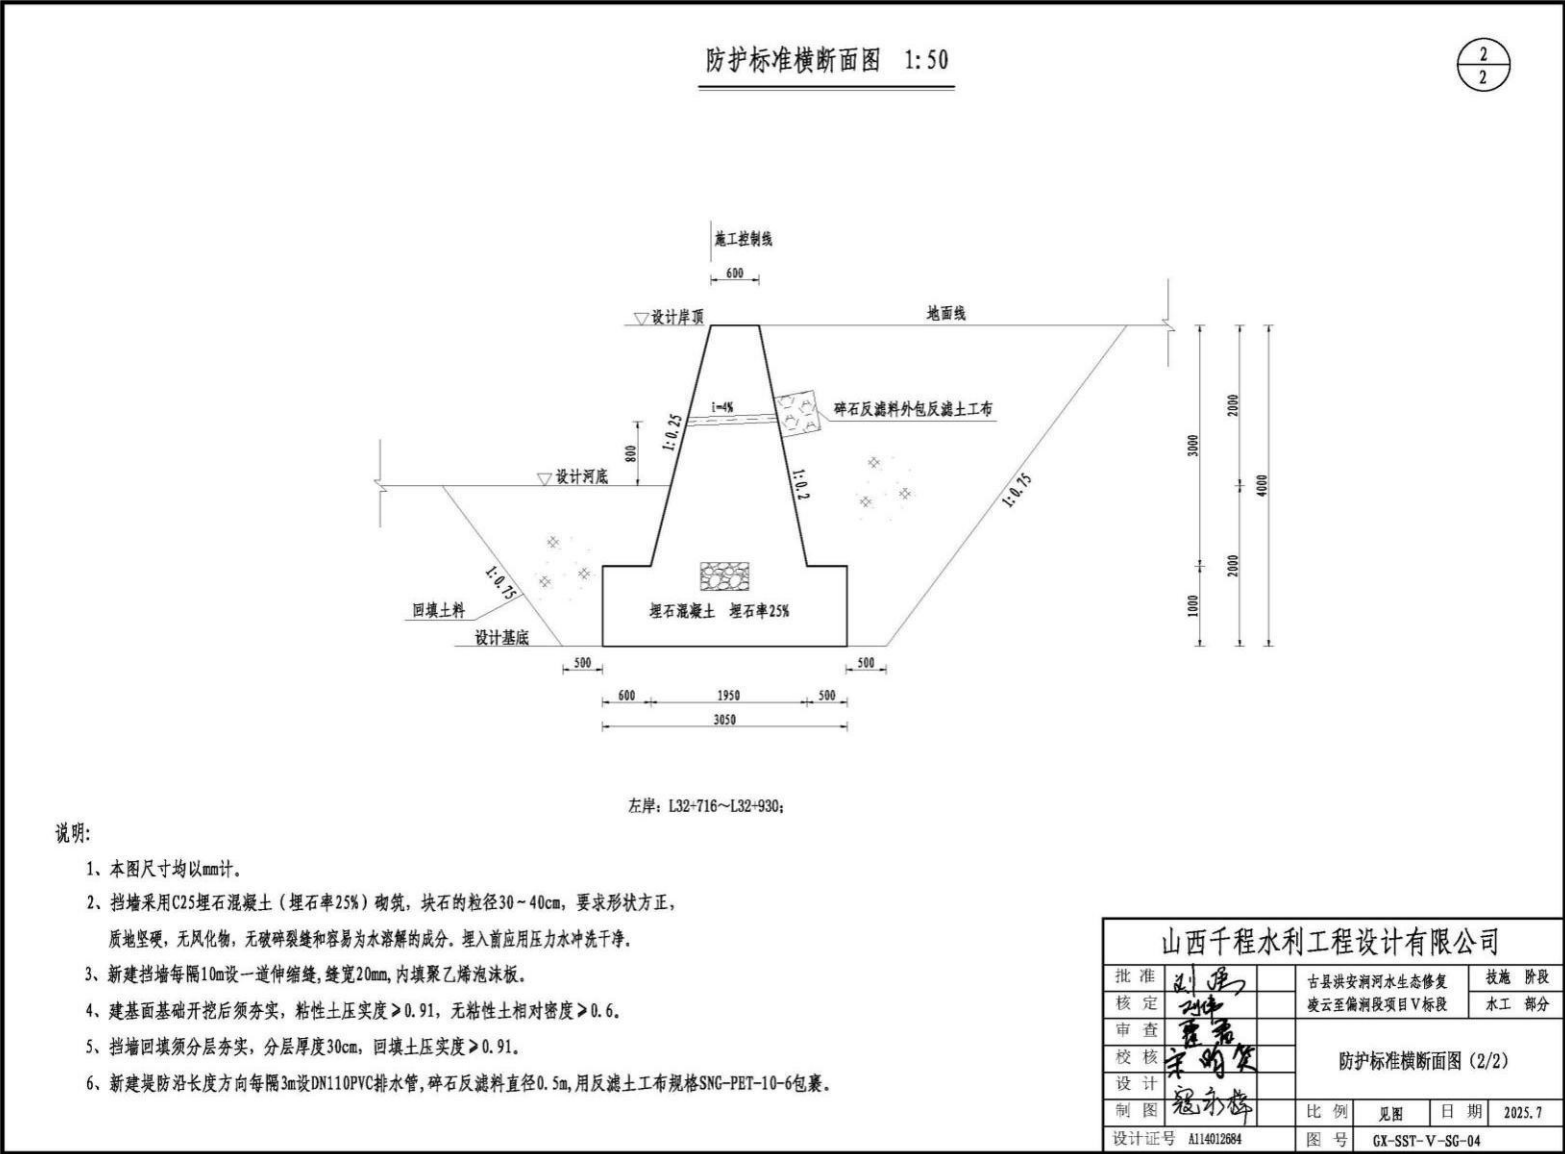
埋石混凝土重力式坡脚防护横断面图
